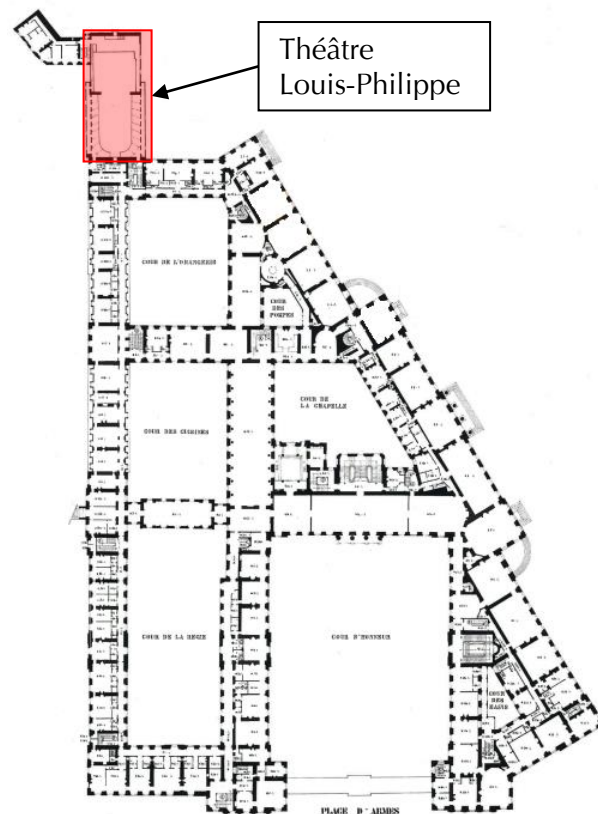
plan du R+1 et localisation des espaces concernés, plan architecte
